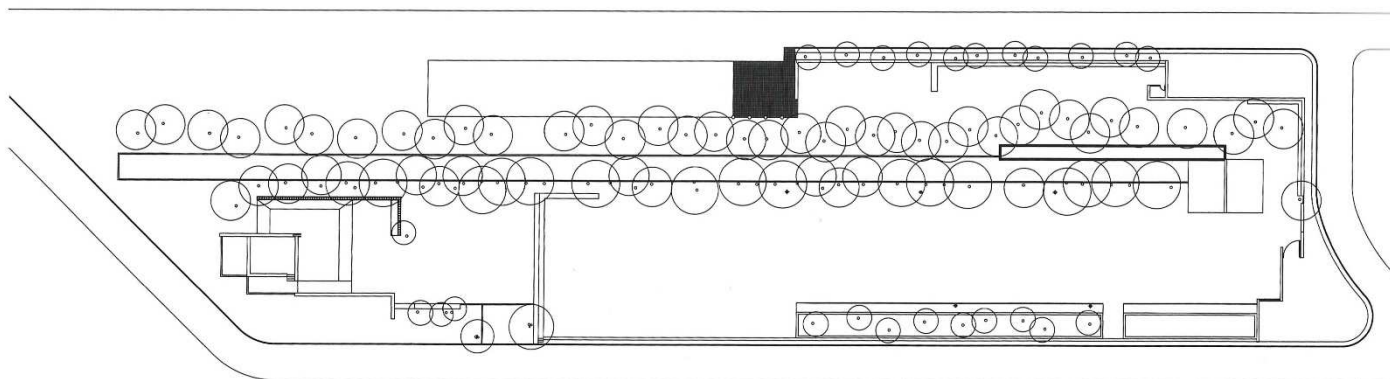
PLANTA DO ESPAÇO COMPLETO – IMAGEM:
